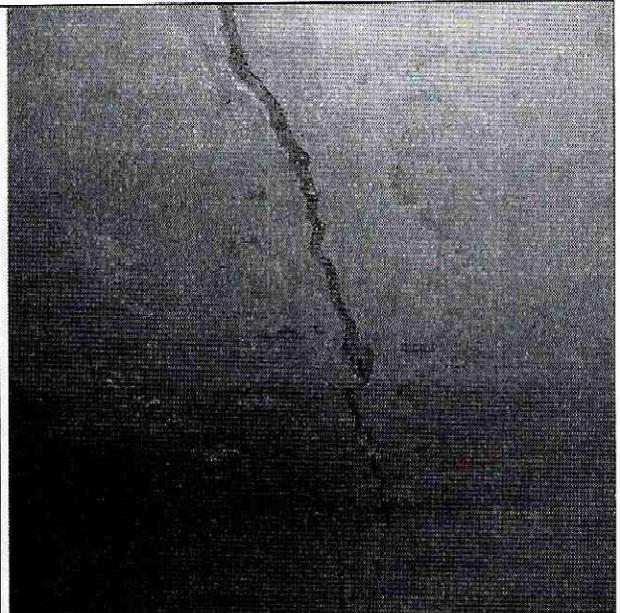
Vista interior del muro de cerramiento del predio de la Carrera 1A # 100 – 35 Sur. Se observa la separación, deriva ó pérdida de verticalidad experimentada por el muro y la columna, a causa del proceso de inestabilidad. Separación actual en la corona del muro cercana a los 10 centímetros.
